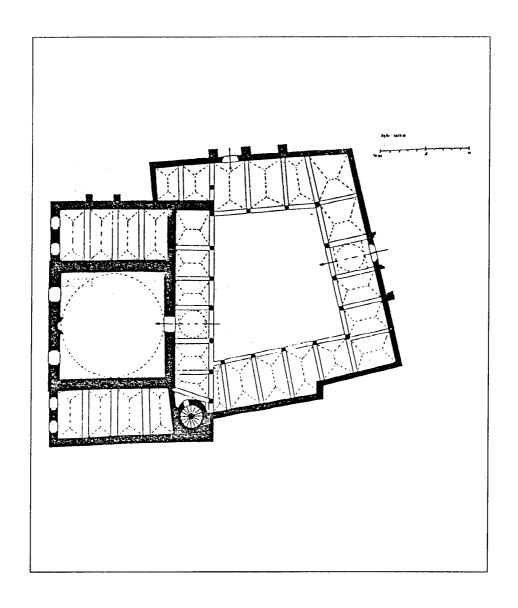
مسقط أنقي لمسجد الخنكار في سراييفو (عن : جودوين) .
